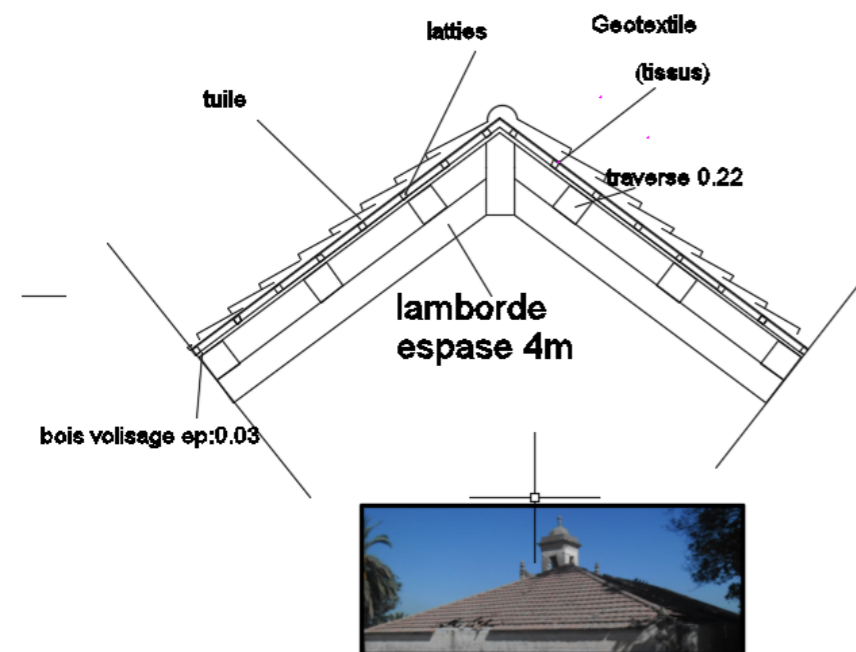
Détail de la toiture. Source: BET Handassa wa Bina.
